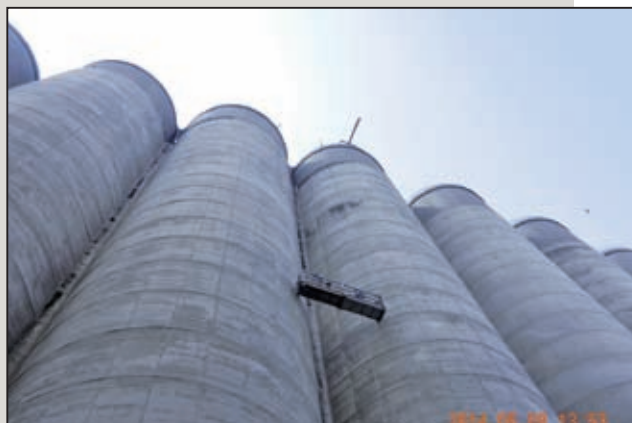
小麥倉鋼筋混凝土外壁目視檢測作業
